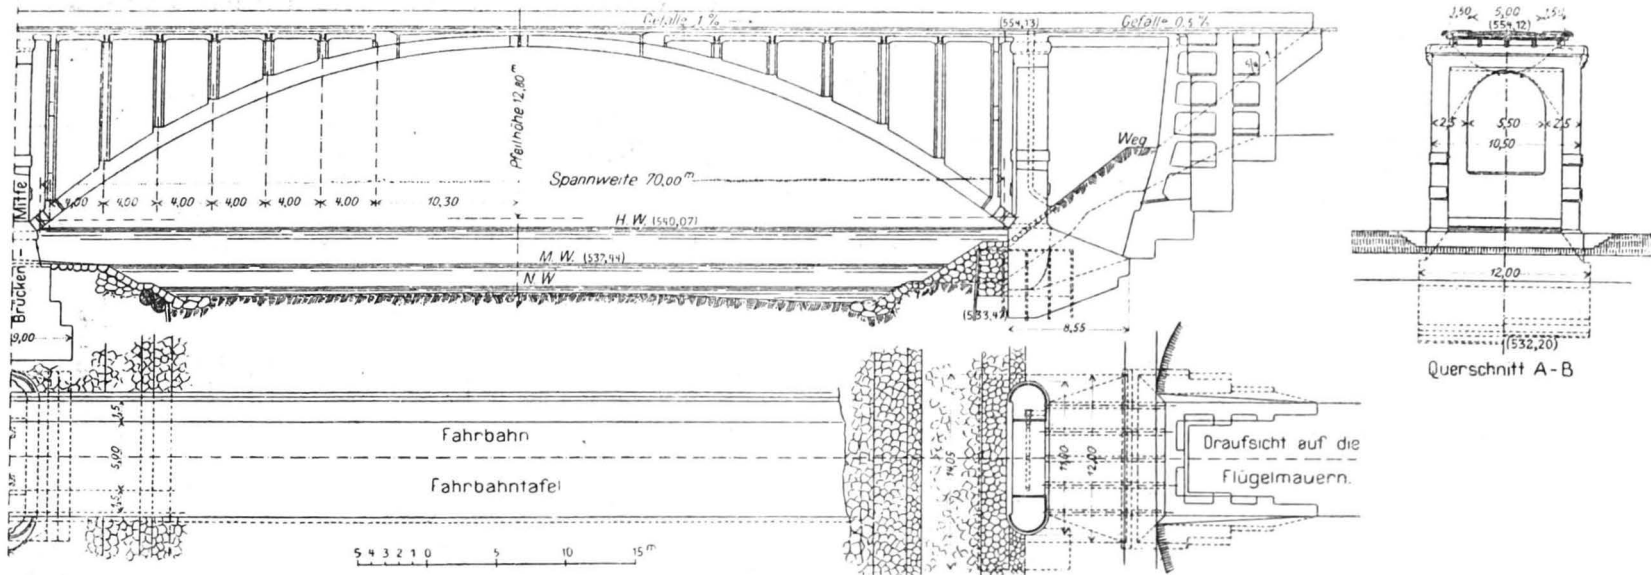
Secție longitudinală, transversală și plan a podului peste Isar lângă Grünwald. Jumătatea din dreapta.
